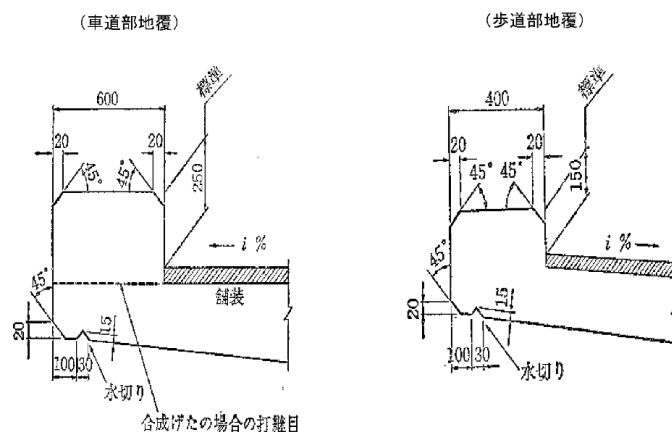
(1) 鋼道路橋設計便覧 (S55.8) 地覆部詳細図 [5]
